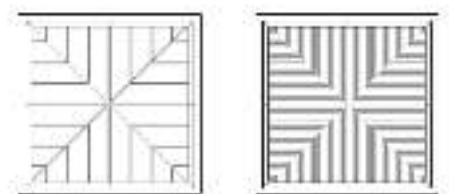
Planta de estrutura e de cobertura de um telhado de tesoura
